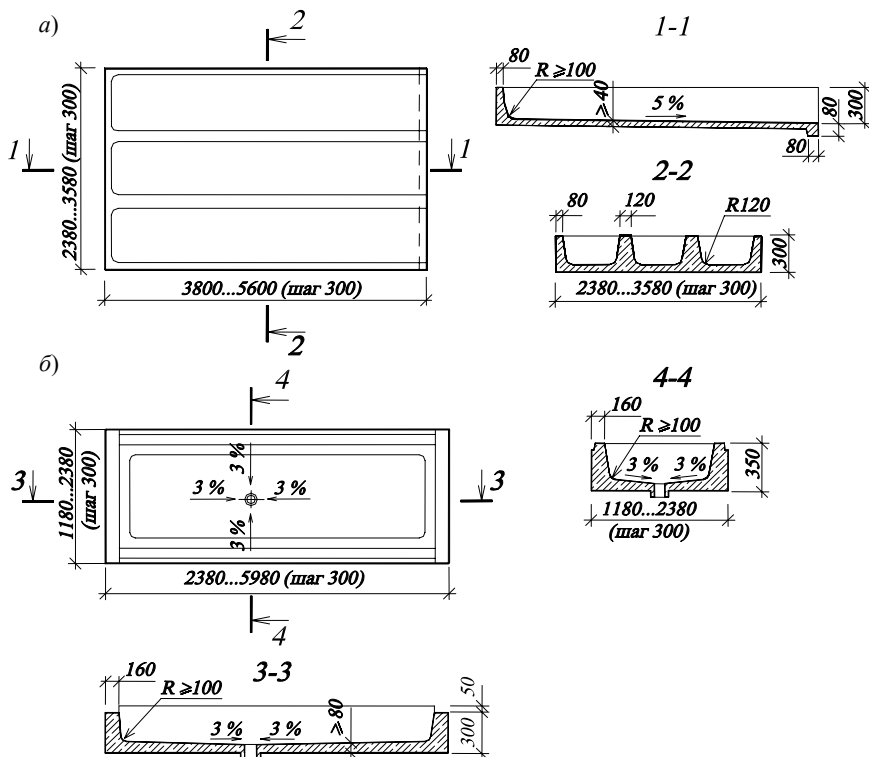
Сборные железобетонные элементы покрытия крыш с холодным и теплым чердаком и рулонной кровлей: а – ребристые кровельные панели; б – водосборные лотки
